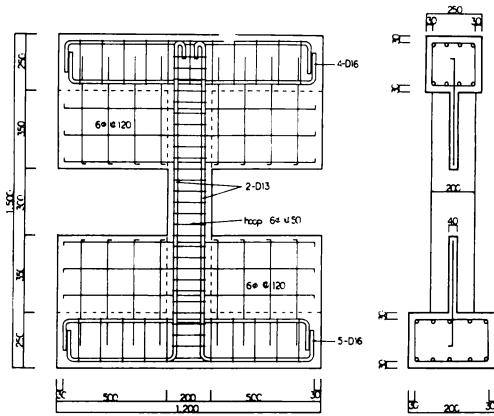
(e) 試験体 CSS05 の配筋図 (寸法単位mm)
